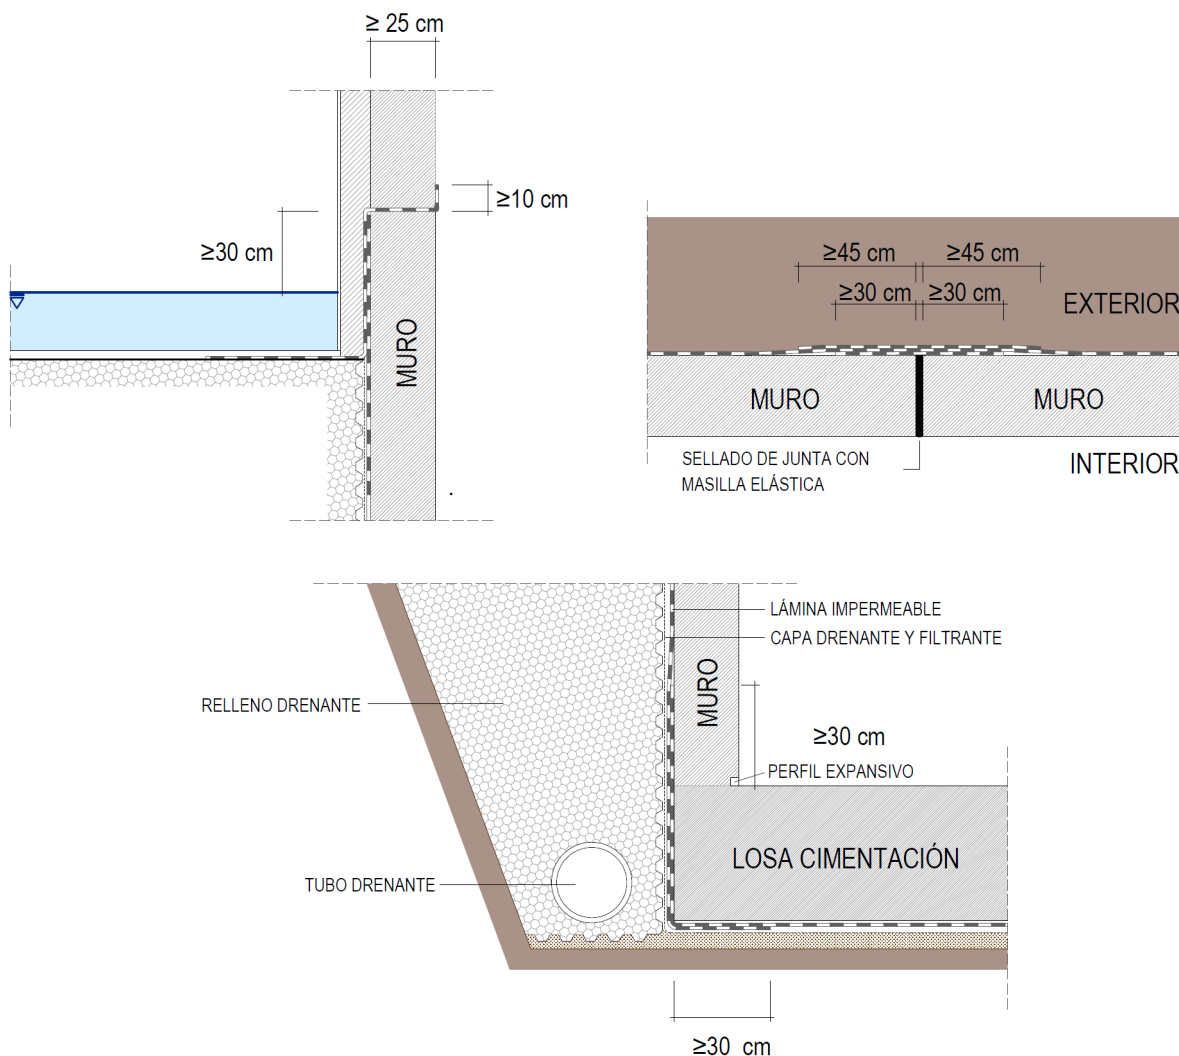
Encuentros del muro de sótano con el solado o losa de cimentación, y sellado de muros.
